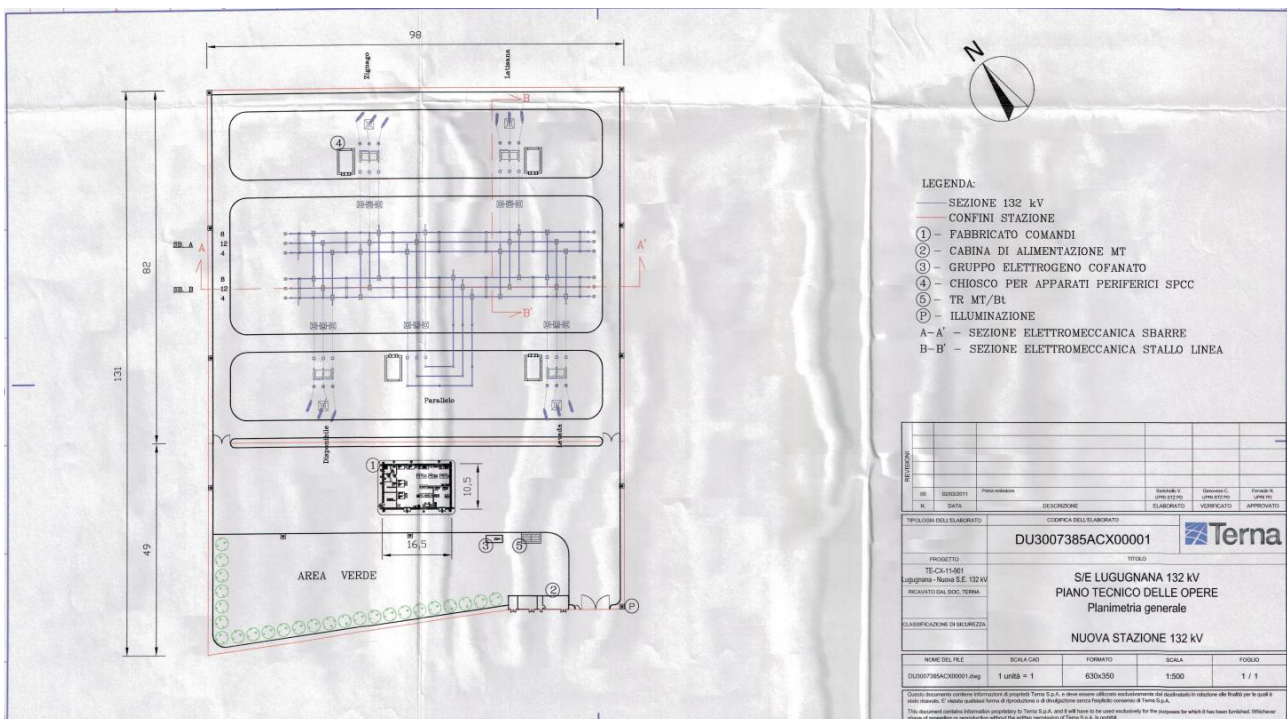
Planimetria elettromeccanica nuova SE di smistamento 132 kV della RTN
